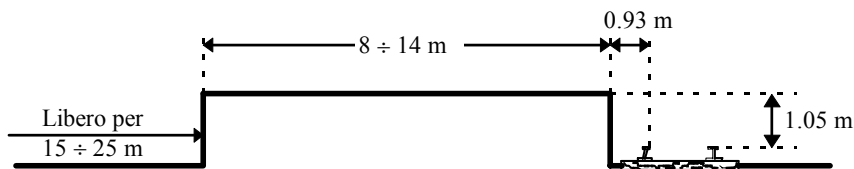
Sezione trasversale di un piano cariatore.
